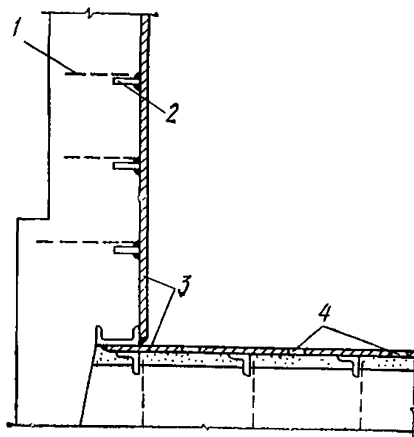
Пример решения сопряжения стальной гидроизоляции стен и дна (3)
